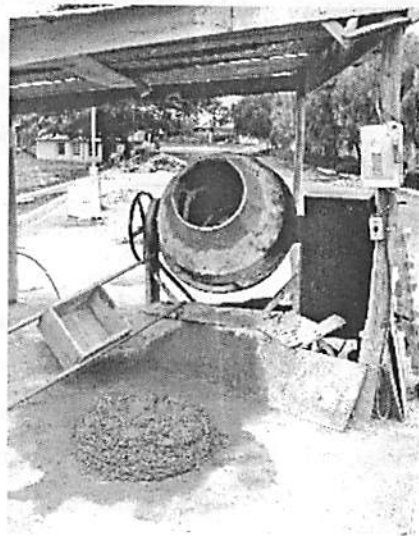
Betoneira, tablado de madeira e padiola.
